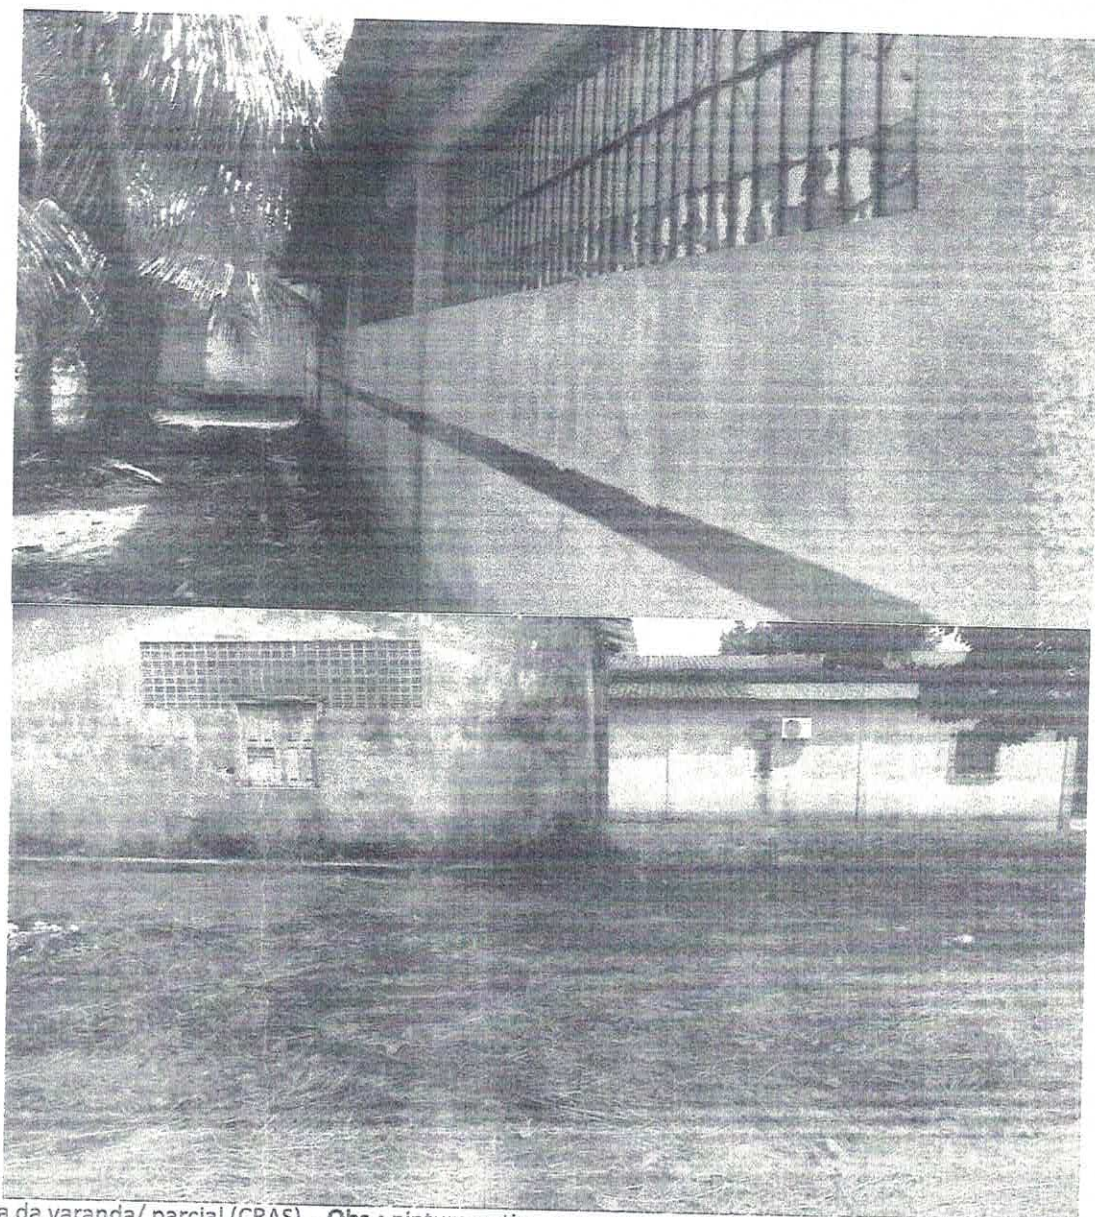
Vista da varanda/ parcial (CRAS) – Obs.: pintura antiga nos muros, piso desgastado e quebrado, portão de grade à ser substituído por portão de chapa metálica lisa ou metálica fechada (Espaço de construção da rampa de acessibilidade);
